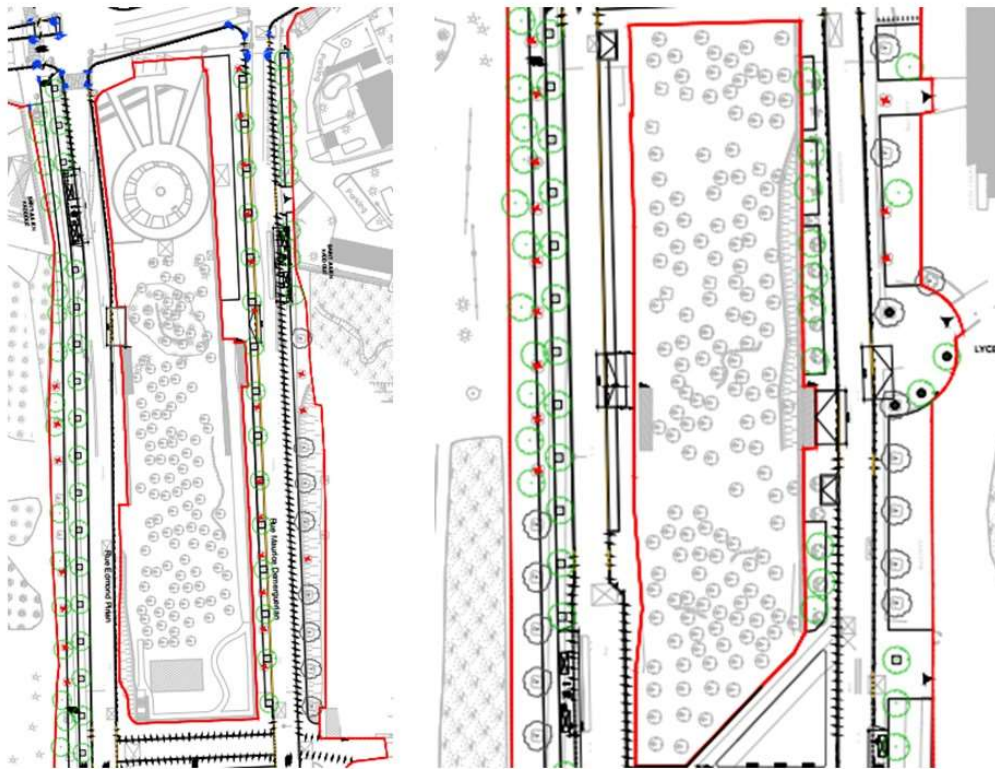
plan de plantation secteur Pirian / Demerguerian
